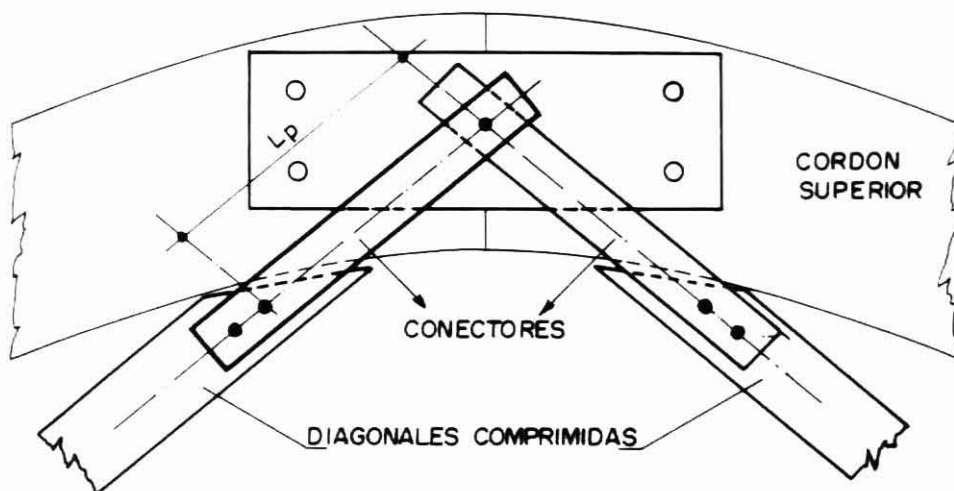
Elementos metálicos sometidos a compresión.
